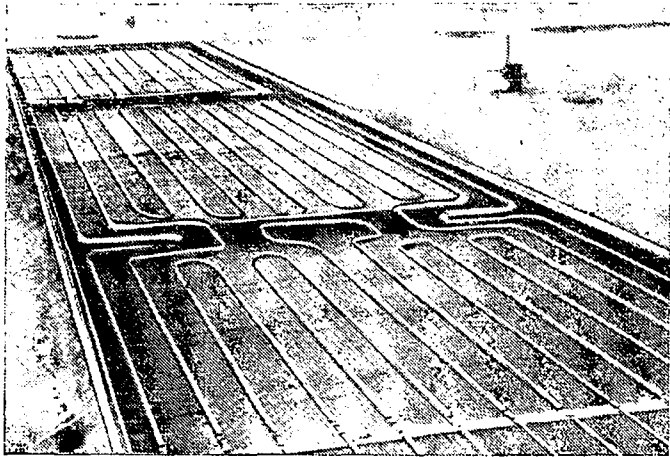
Общий вид смонтированных трубопроводов напольного отопления
